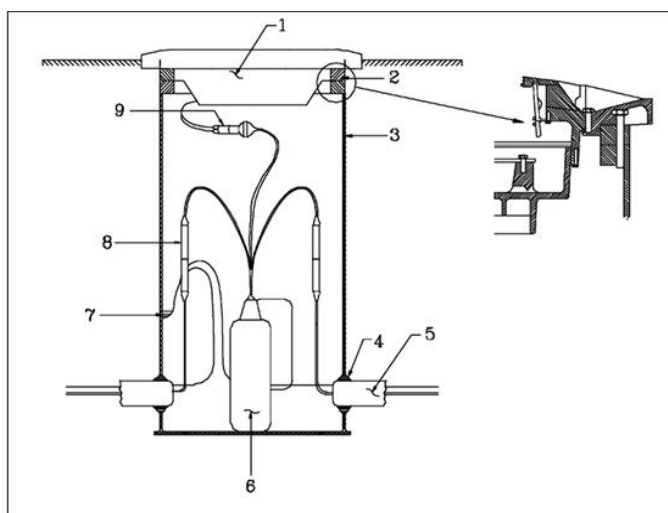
Conjunto de luminaria empotrada (Corte transversal)
